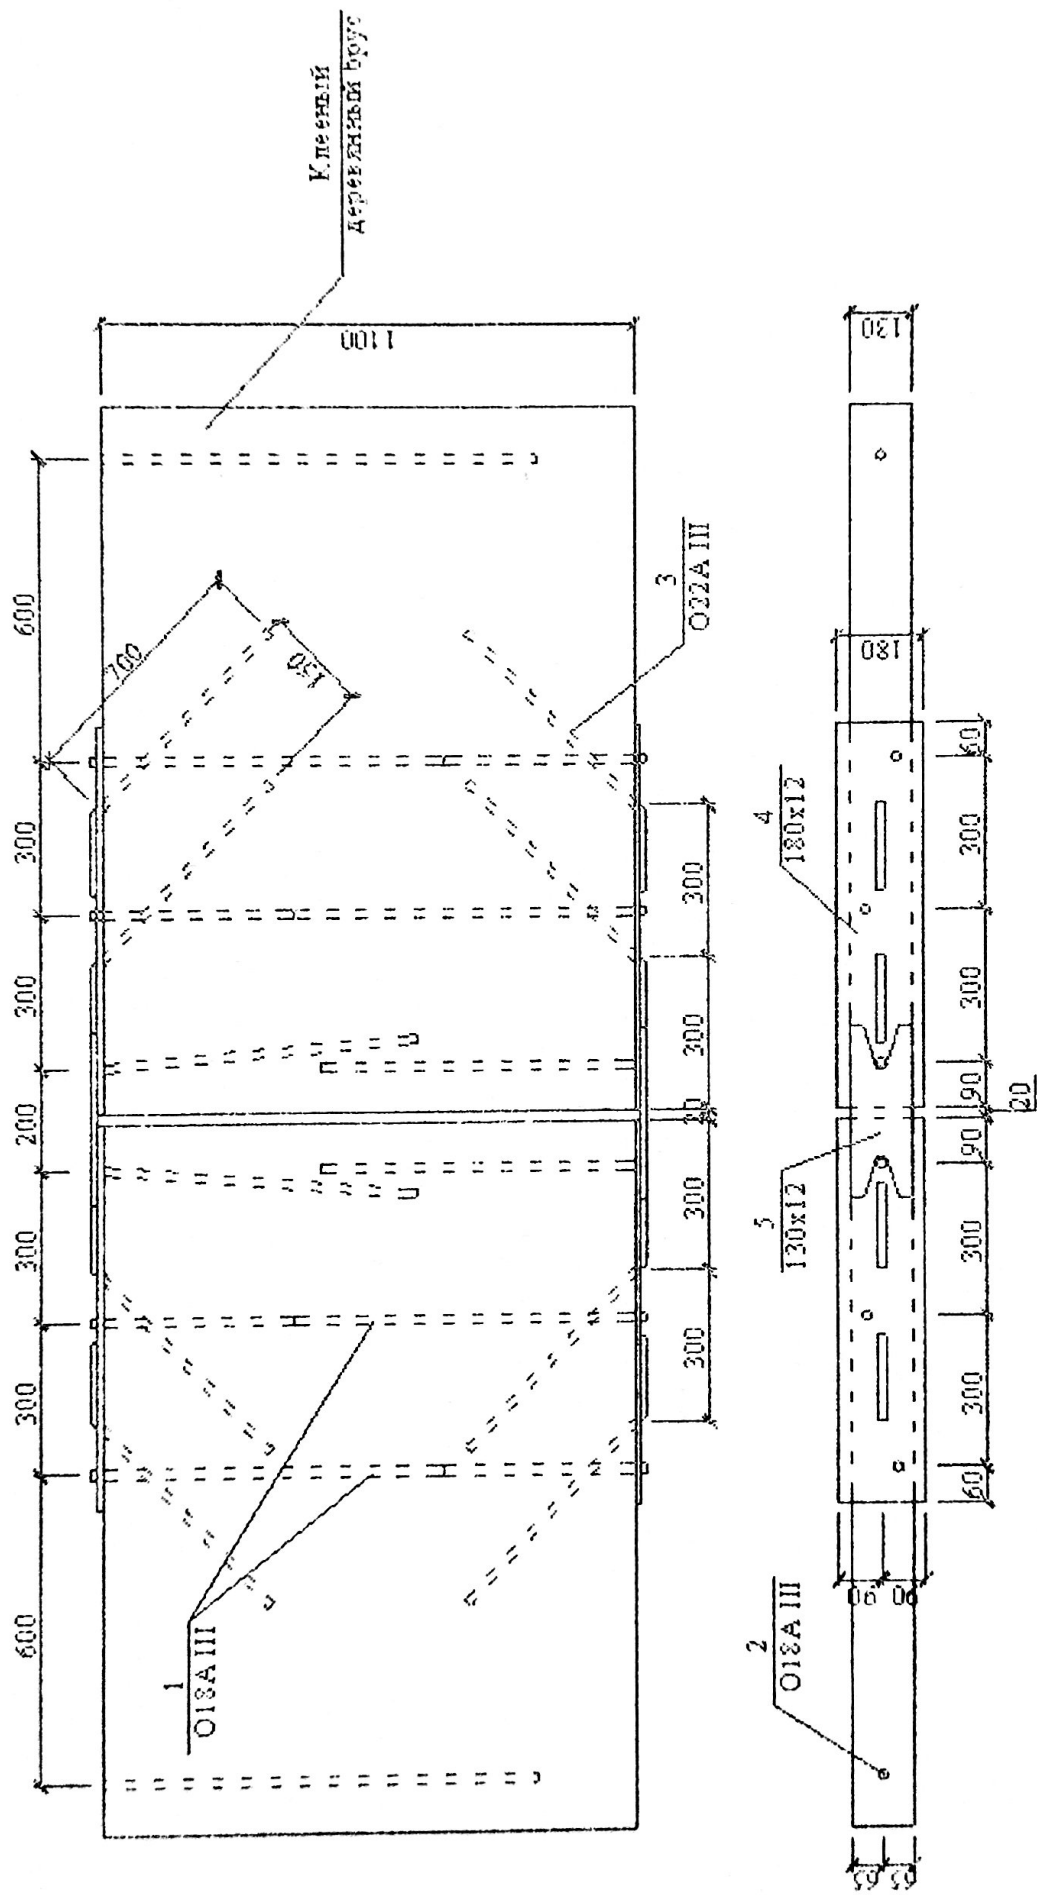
Узловое соединение железобетонных элементов сечением 130x1100 мм разработанное в ЦНИИСК под руководством С. Б. Туркеского
